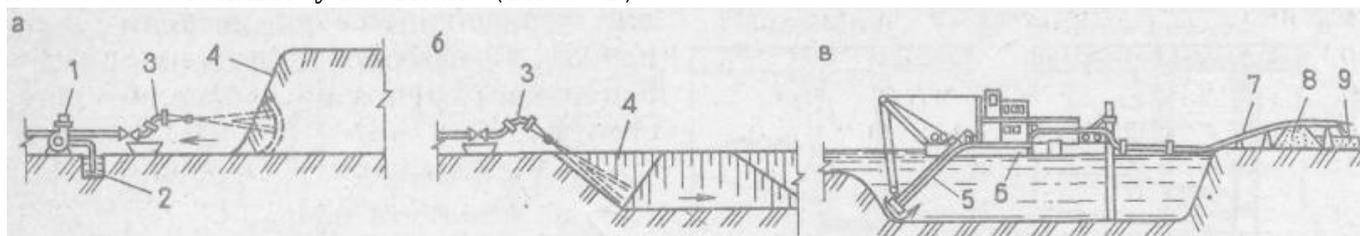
Схемы разработки грунта гидромеханическим способом :
